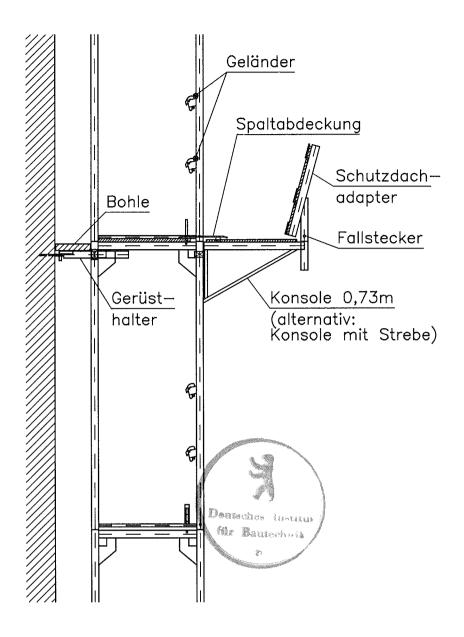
Schutzdach mit Konsolen 0,73 m und Schutzdachadaptern
